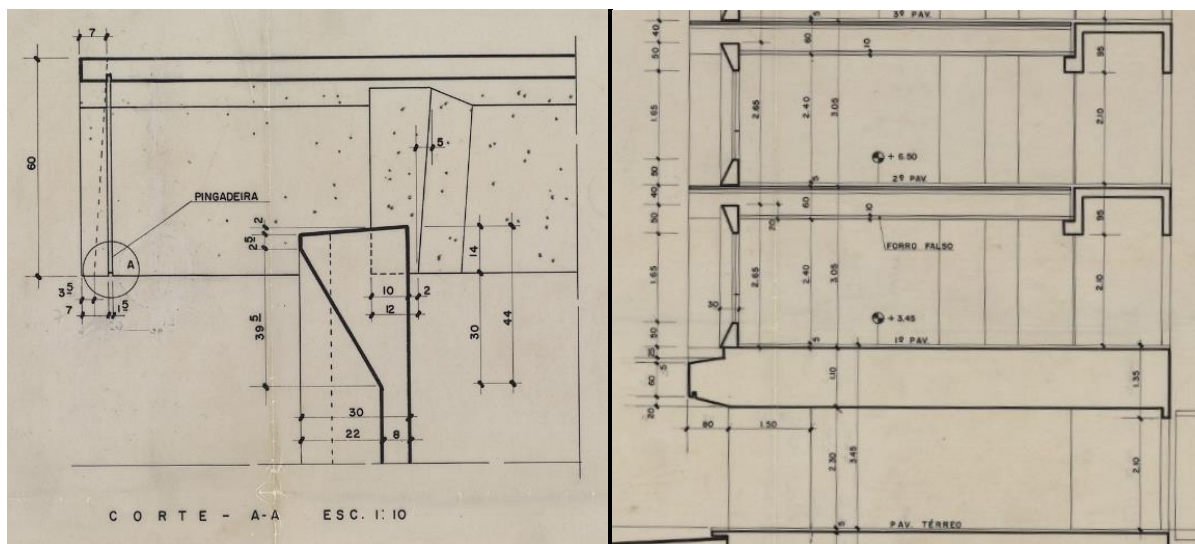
Detalhe do encontro entre vigã e painel de vedação e da vigã à estrutura moldada no local por meio de consolo e contato direto. Fonte: Acervo do Arquiteto Milton Ramos.
